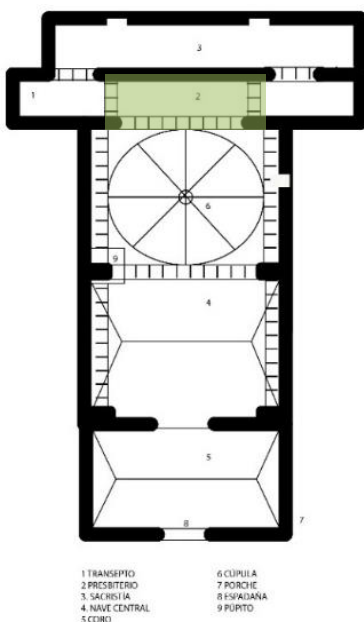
Plano simplificado en planta de la ermita de San Gregorio.
